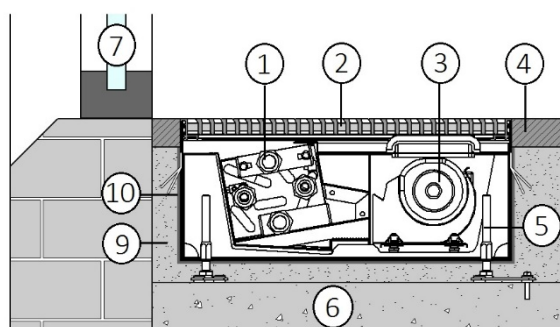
dettaglio di un montaggio in pavimenti grezzi
